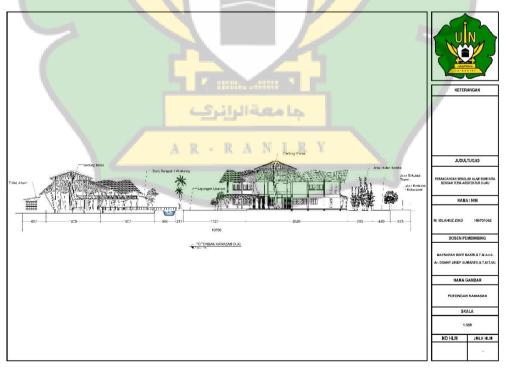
2 Layout plan massa bangunan Sumber : Dokumen Pribadi
